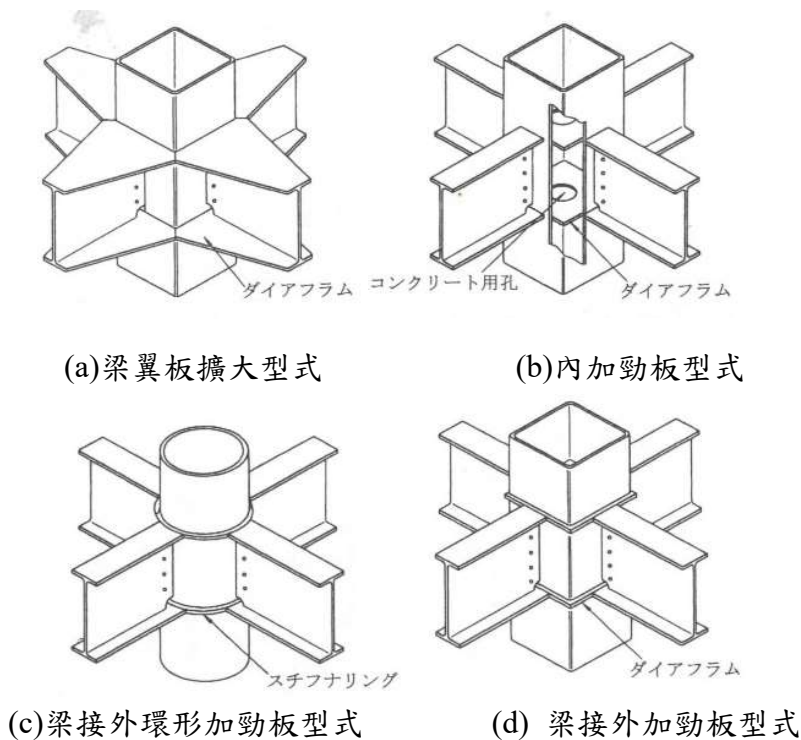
鋼管鋼筋混凝土常見接合型式 (AIJ-SRC, 2014)
